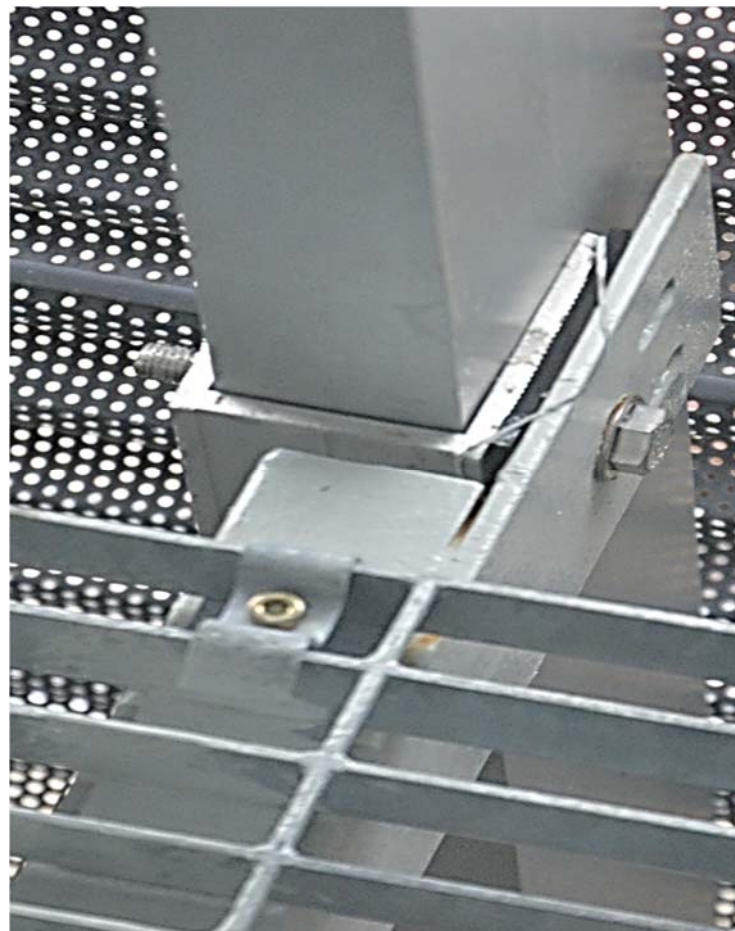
Centro Parque Battle | Detalle de encuentro de estructura de acero y tubulares de aluminio.:
